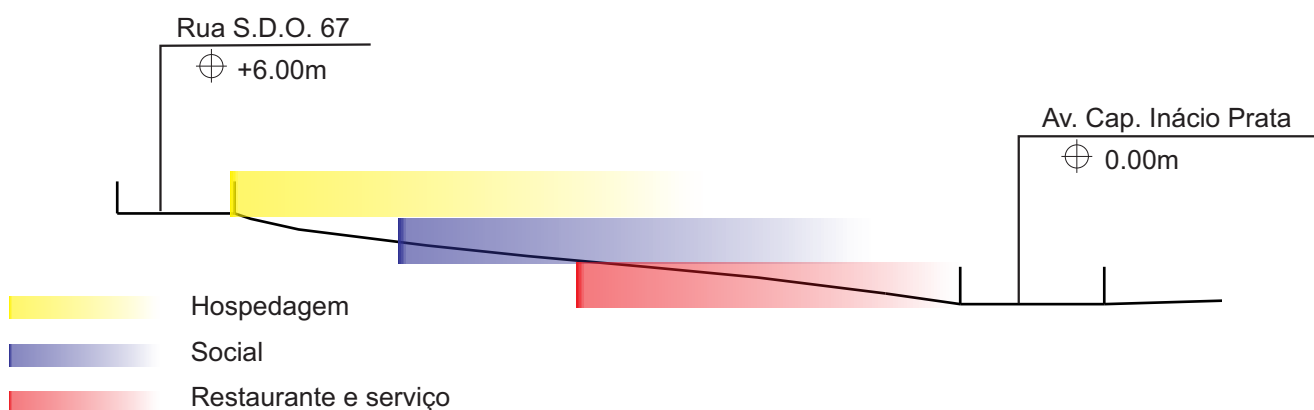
Corte esquemático da implantação - Escala 1/1250
